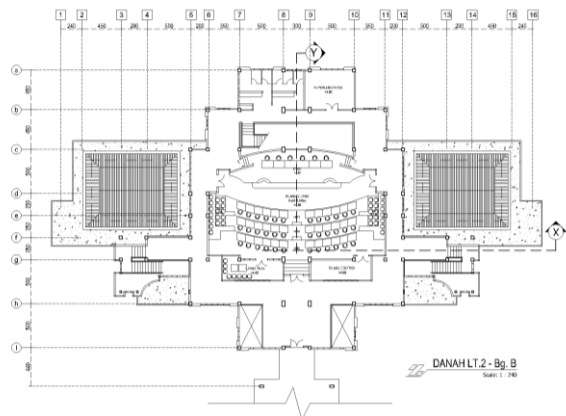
Denah Lantai Dua Gedung Utama (Sumber : Pribadi)
